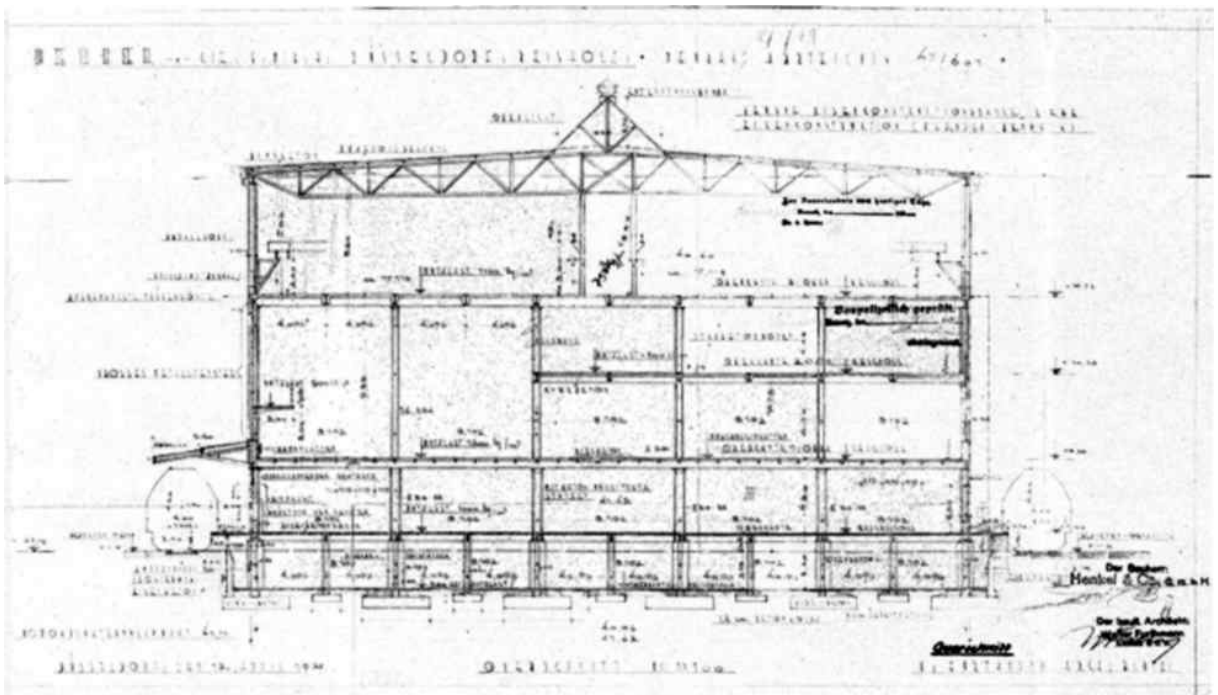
Neubau Packereigebäude Geb. C 05, 1929 - Architekt: Walter Furthmann
